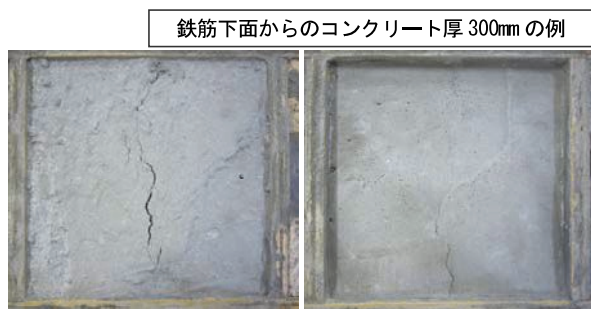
再振動締固めの有無による沈下ひび割れ状況
